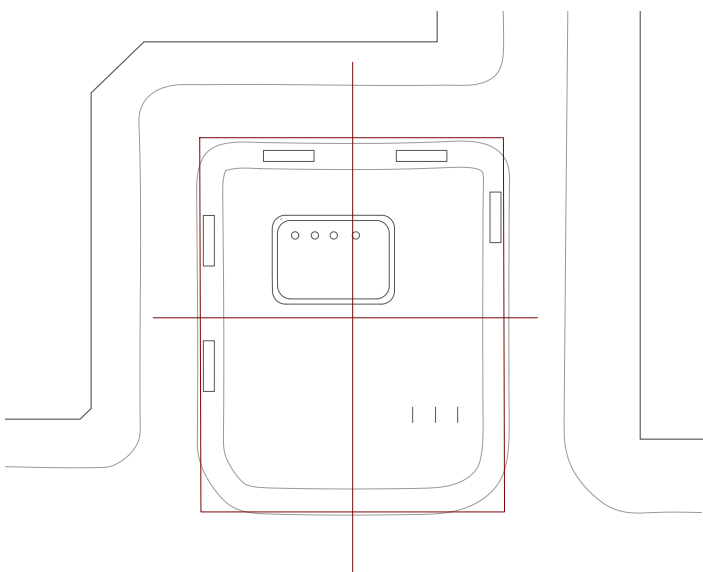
Planta parque Bertelmanplein. Elaboración propia
